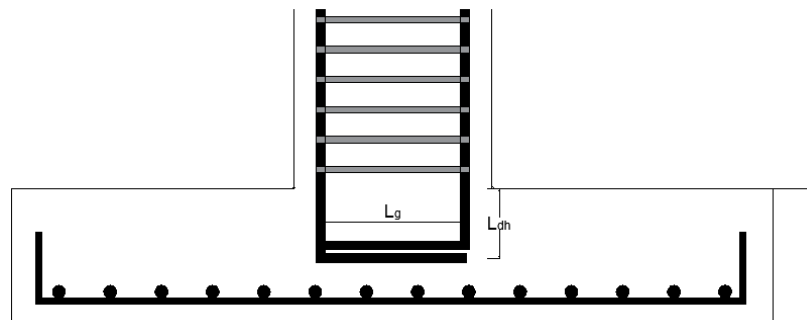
62 Detalle para ganchos a 90° en pedestales.
